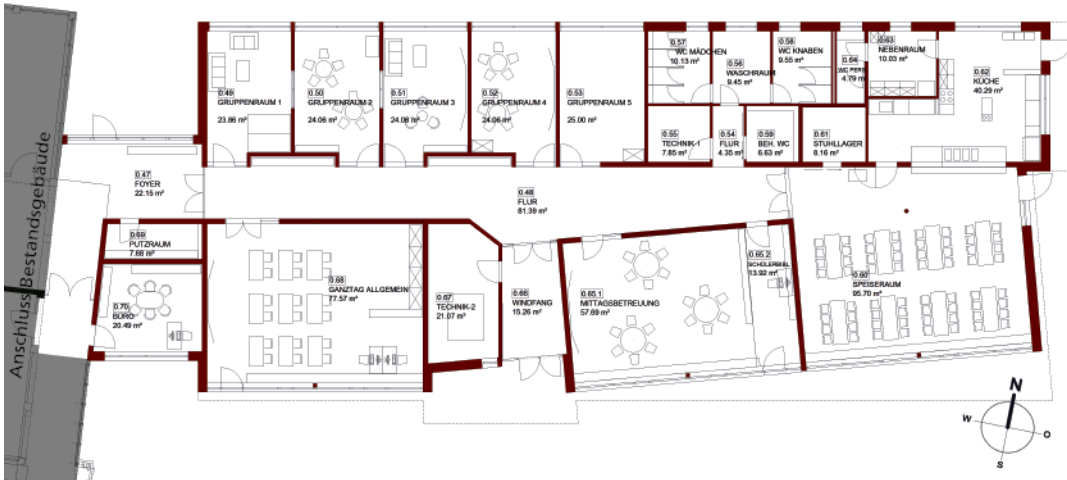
Erdgeschoss-Grundriss des Erweiterungsbaus
